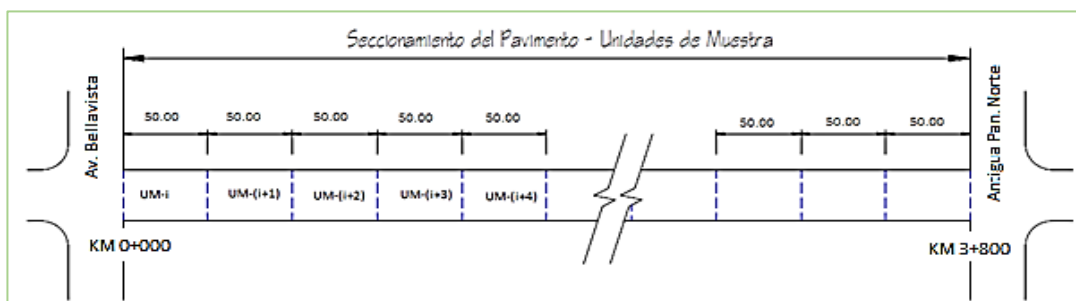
Seccionamiento del pavimento en unidades de muestra de la Av. Cincuentenario
